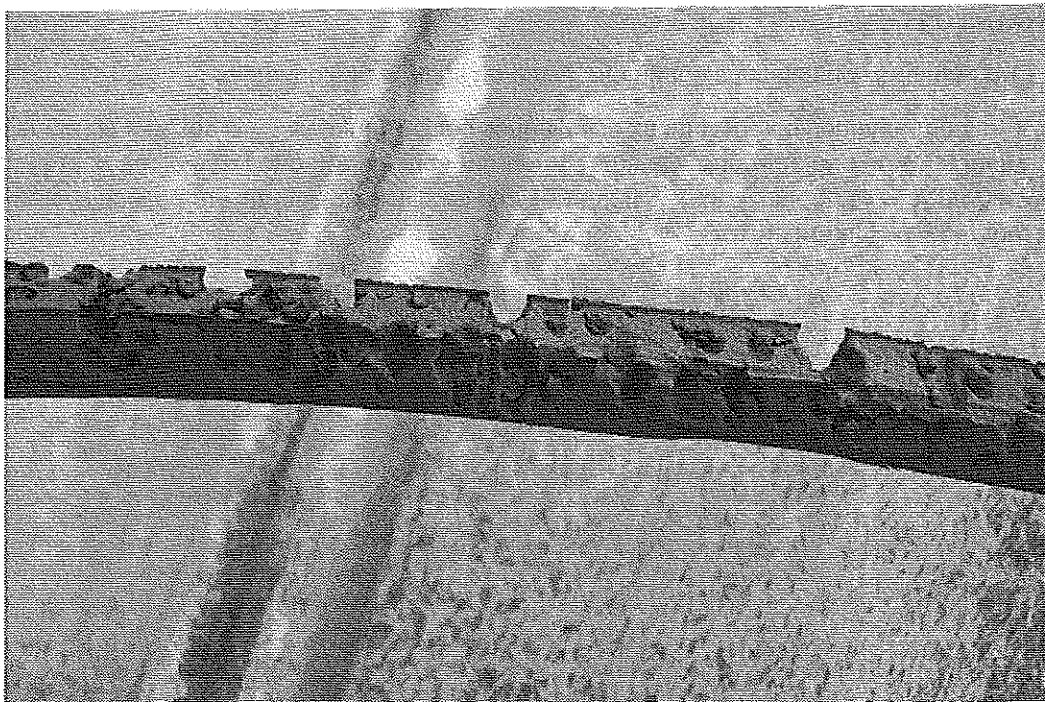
Détail d'une garniture de joint attaquée par les oiseaux. © J. Putatti
